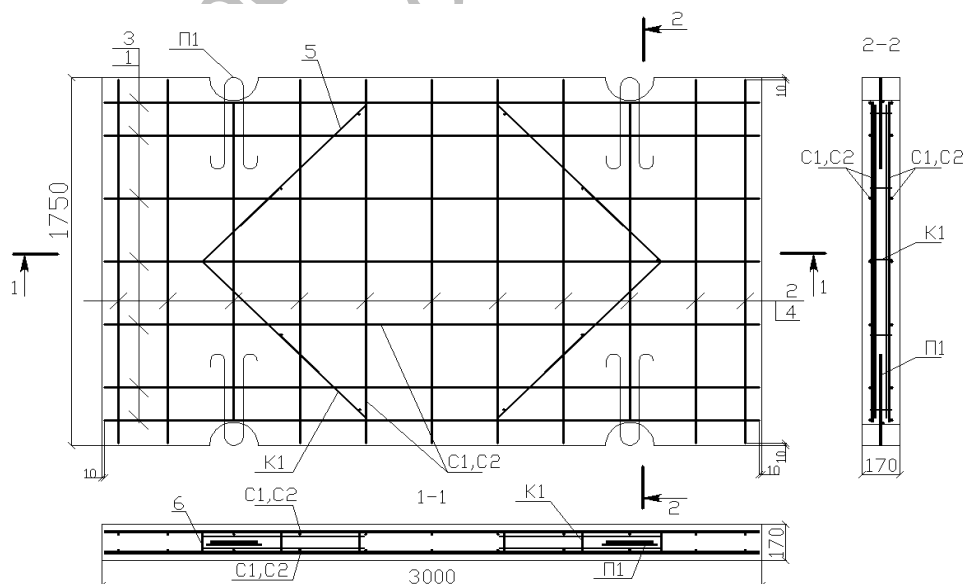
Опалубочные чертежи и схемы армирования плит железобетонных для покрытий автомобильных дорог марок 1ППЗ0.18–30, 2ППЗ0.18–30
